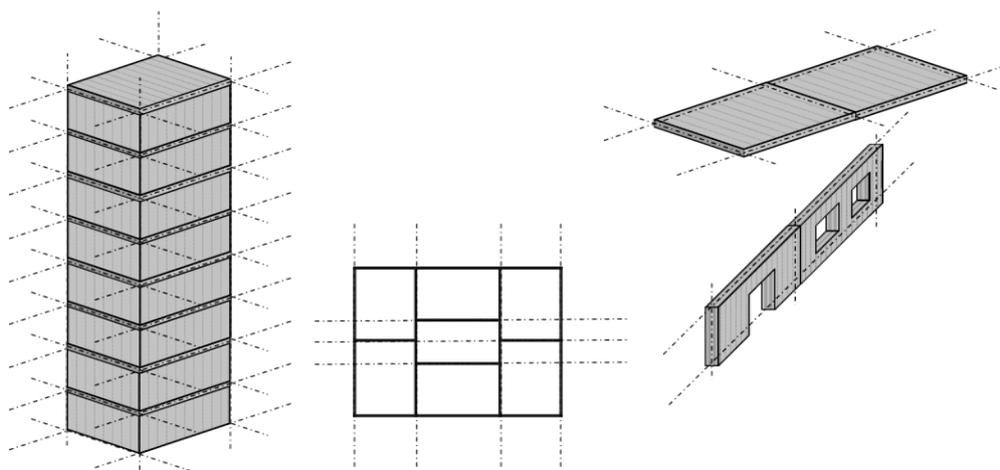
Lignes d'assemblage d'une structure tridimensionnelle complexe
